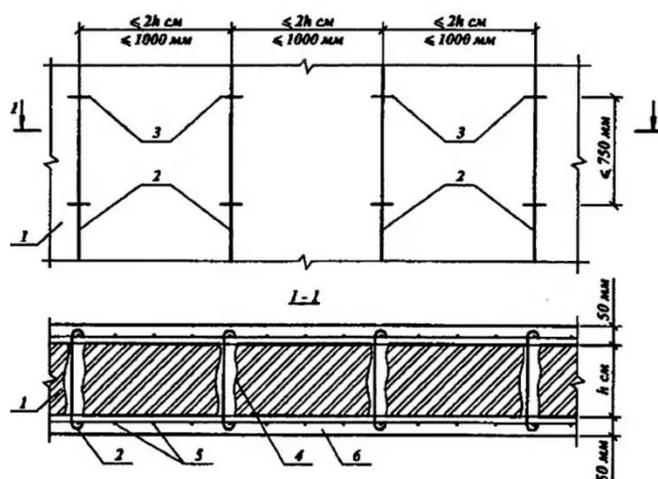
Усиление стен ж/б обоймой [1], где 1 – усиливаемая стена; 2 – арматурные стержни; 3 – хомуты-связи; 4 – отверстия в стене; 5 – арматурные сетки; 6 – бетон обоймы
